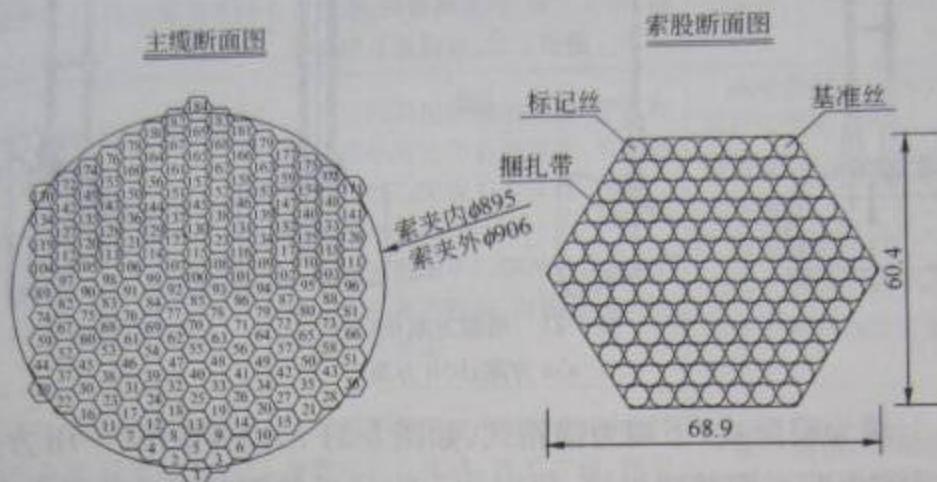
主缆断面、索股断面(尺寸单位:mm)
